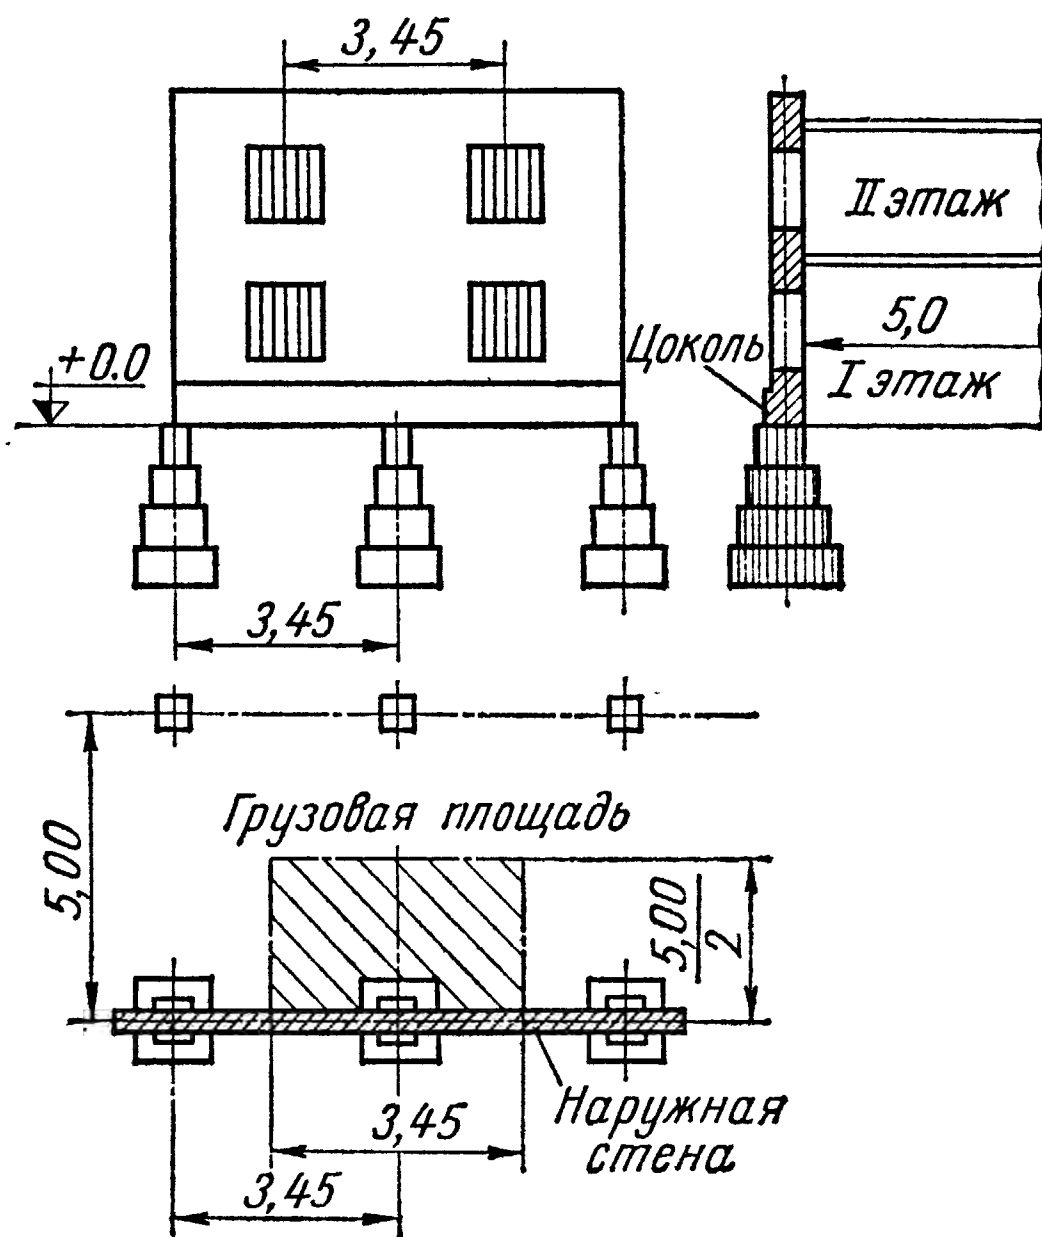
Схема для определения грузовой площади под столб отдельного фундамента
